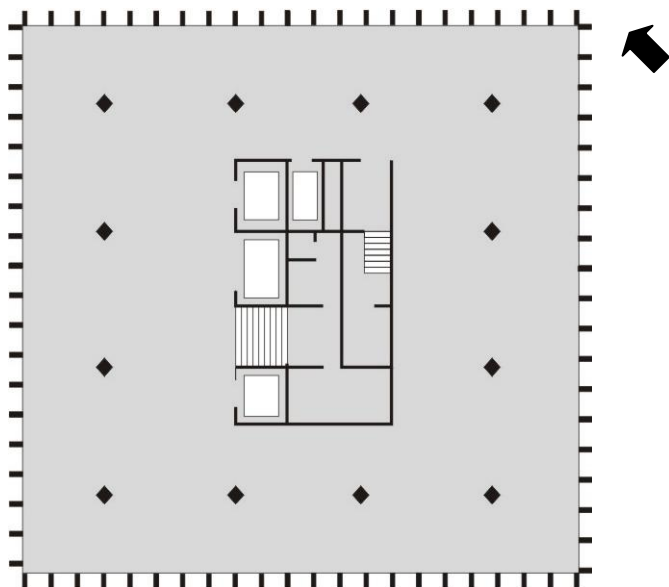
Secretaria Estadual de Educação. Esquema pavimento tipo.
